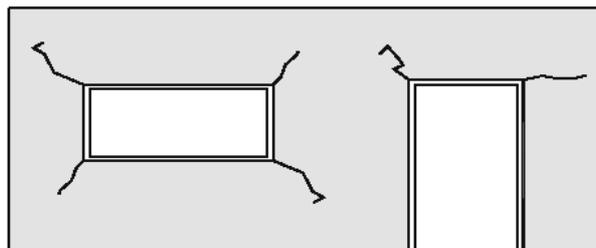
Fissuração típica (real) nos cantos das aberturas, sob actuação excessiva de cargas
